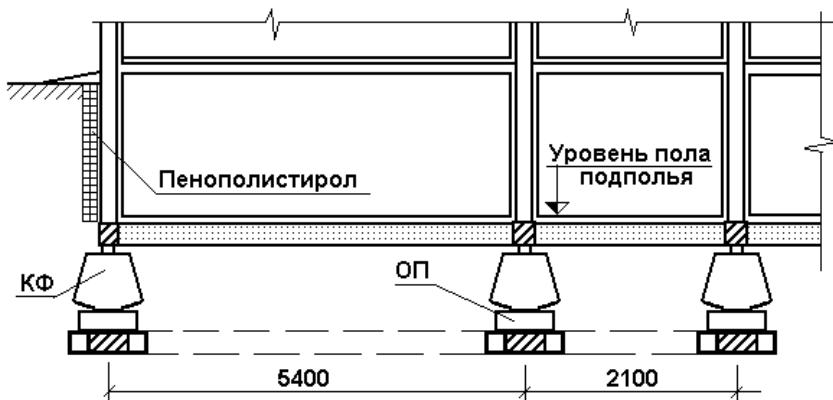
Конструктивное решение сейсмозащиты с использованием кинематических фундаментов ниже несущих стен подвала
